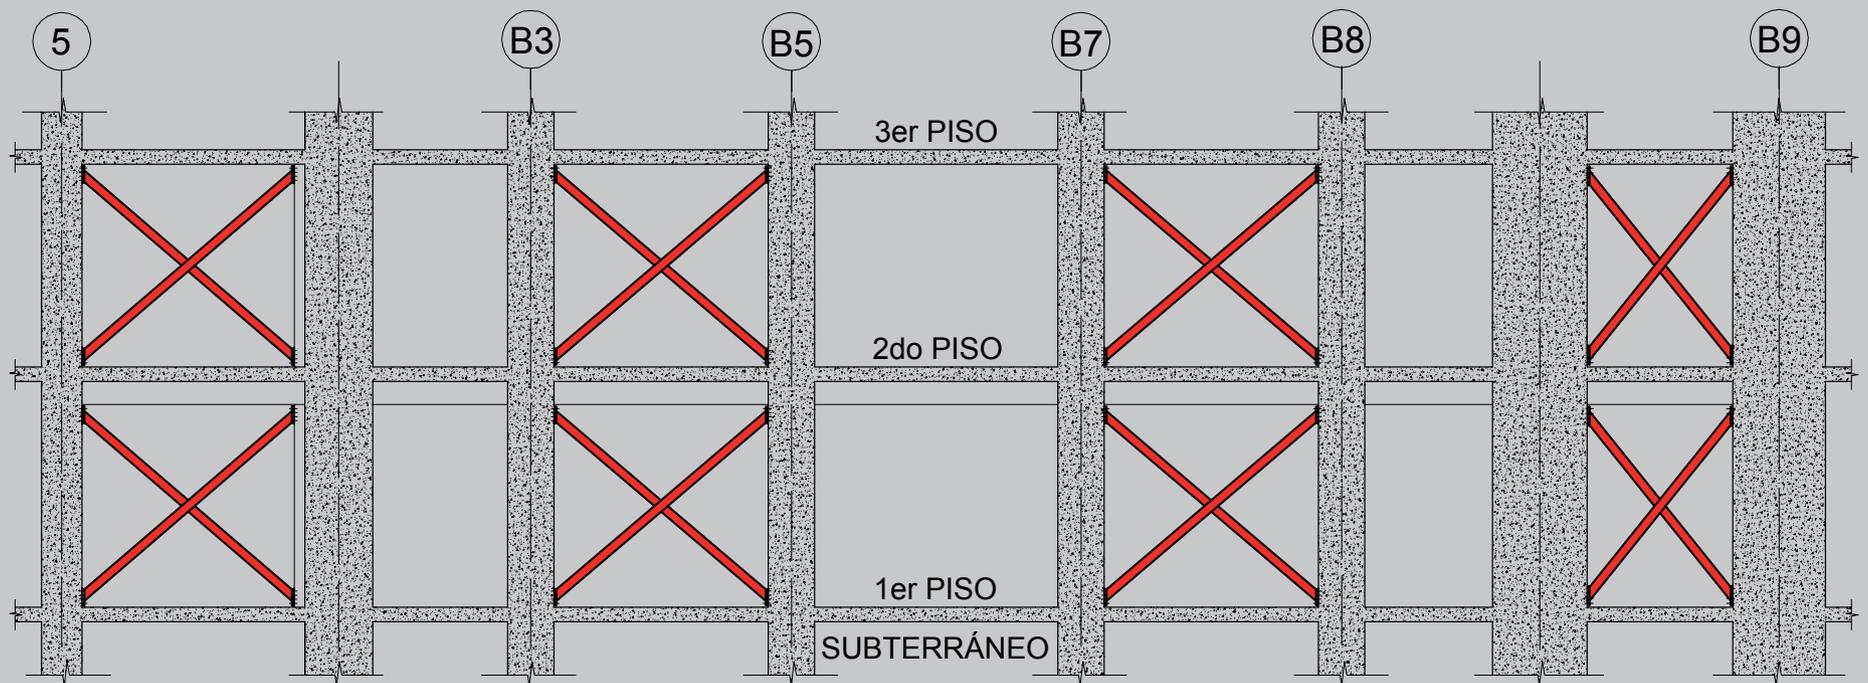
Refuerzo resuelto mediante contravientos de metal. Este refuerzo se localiza por la parte posterior del muro que soporta la obra pictórica.
